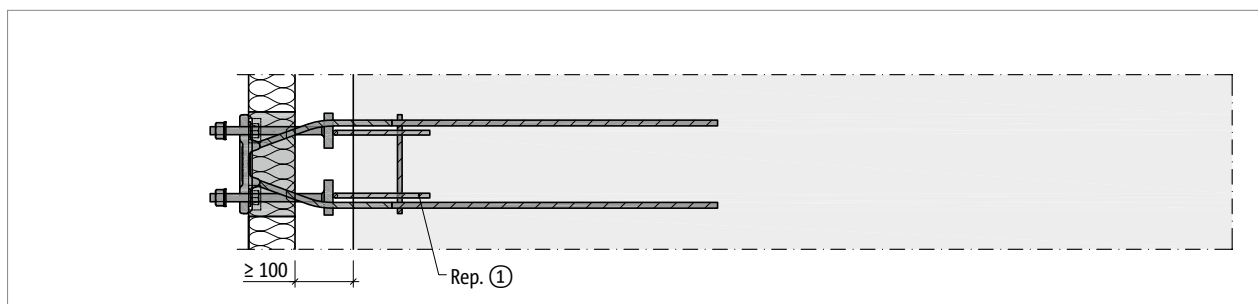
Schöck Isokorb® T type SQ : armatures à prévoir par le client dans le cas d'une construction en prédalle, vue en plan
